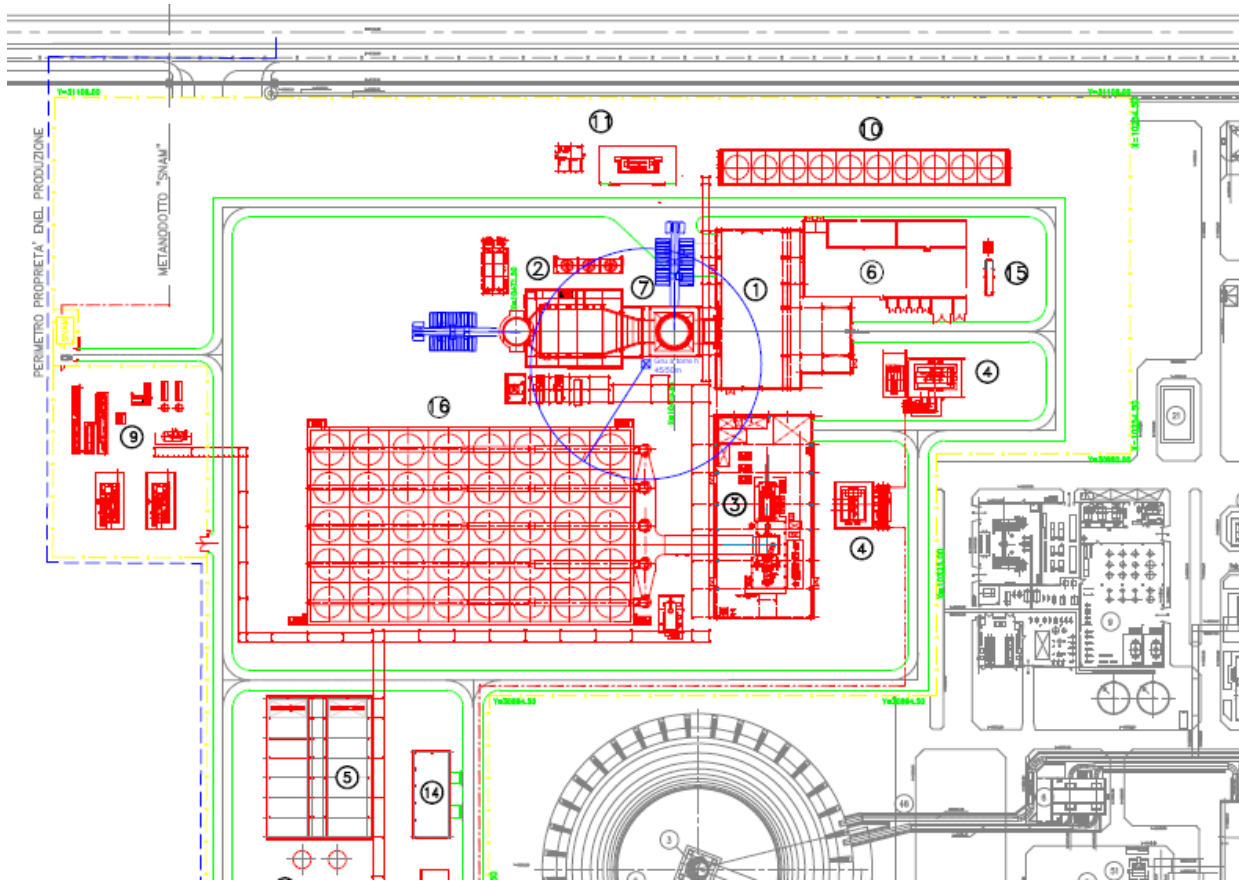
Disposizione tipo mezzi di sollevamento
